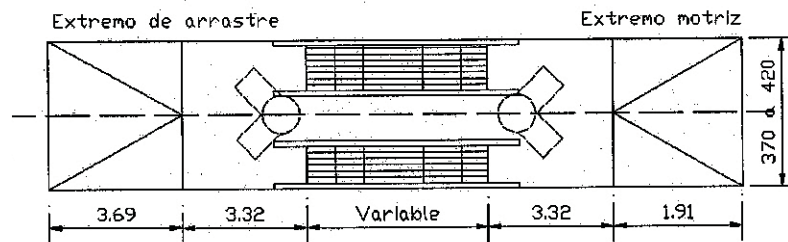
Anchura en rampas eléctricas de doble sentido
